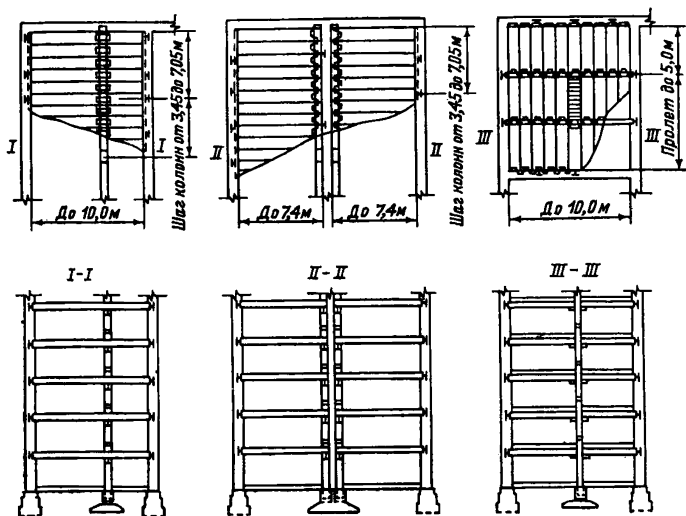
Варианты внутренних несущих каркасов из крупноразмерных железобетонных колонн и прогонов
